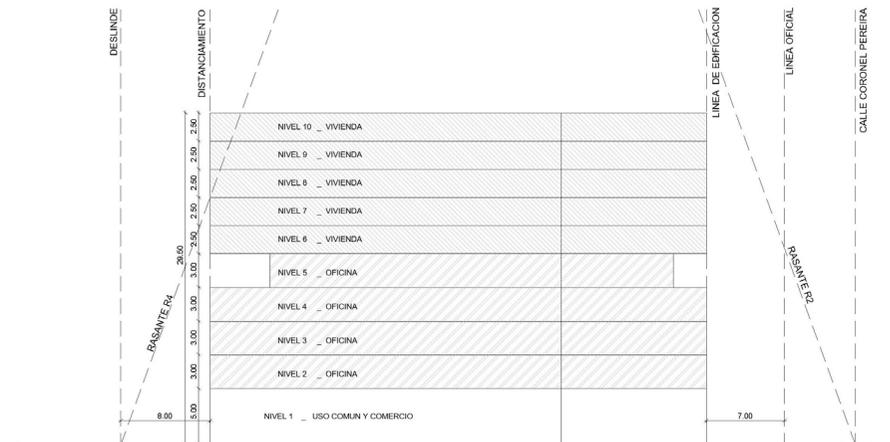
Plantas Tipo Cabida Uso Mixto.
